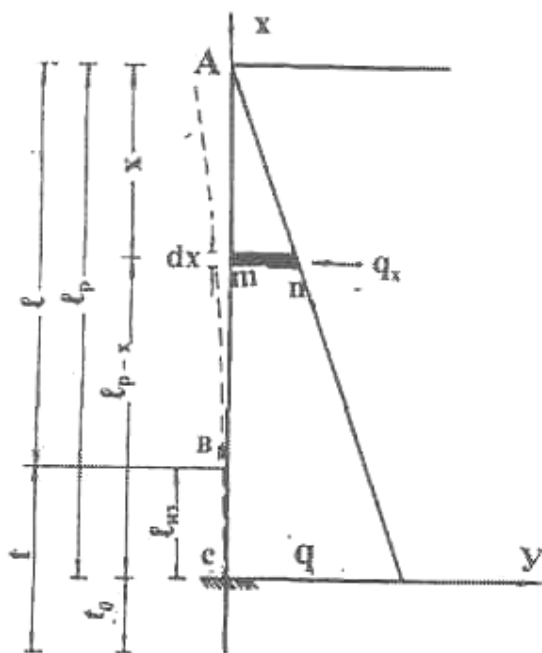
Расчетная схема незаанкеренной шпунтовой стенки
